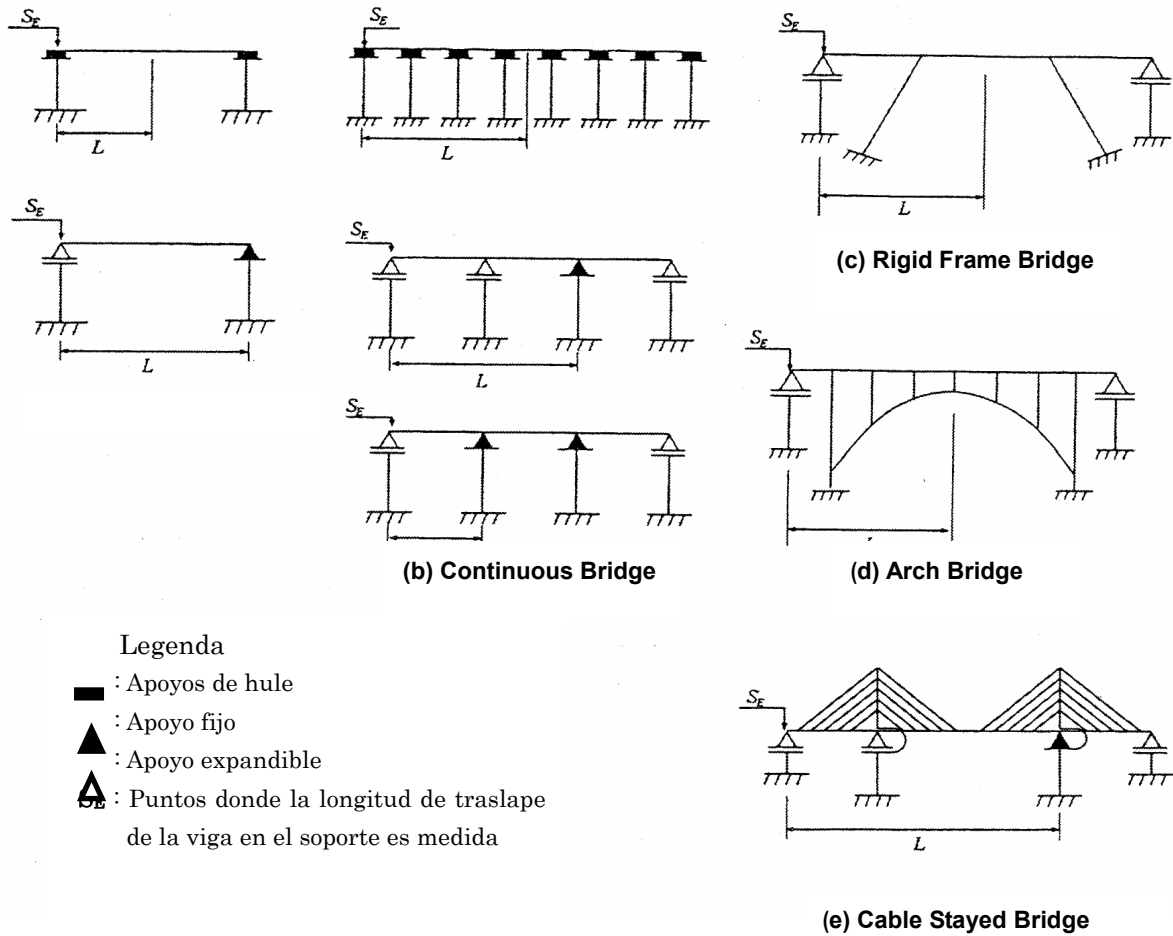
Longitud entre subestructuras para calcular el punto de la longitud del asiento
